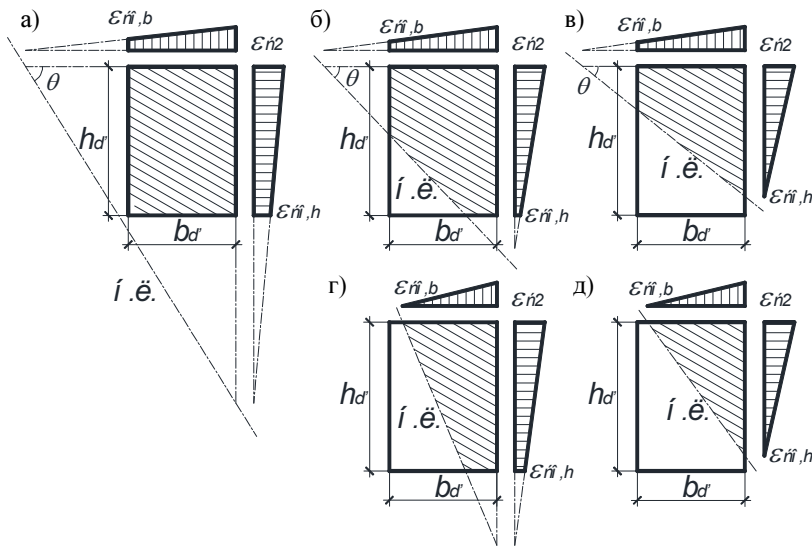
К определению площади сечения сжатого бетона в кососжатом железобетонном элементе
